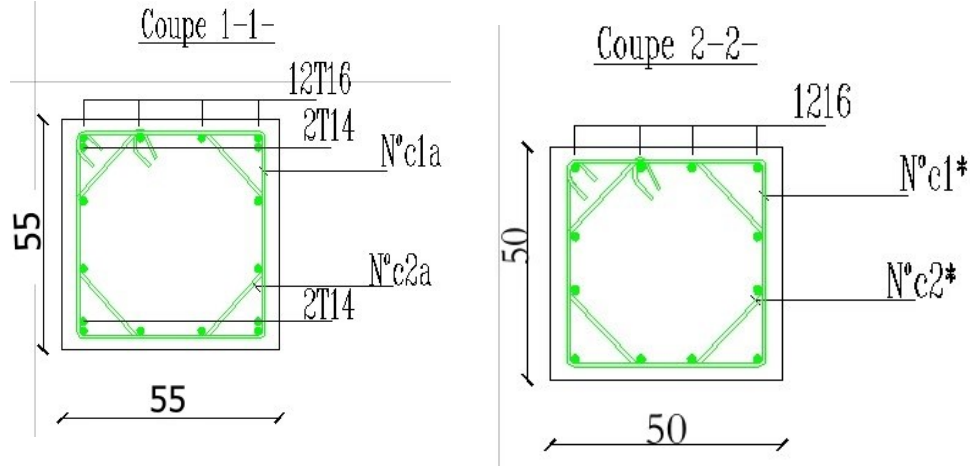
Ferrailage des poteaux de section (55x55) et (50x50) cm
